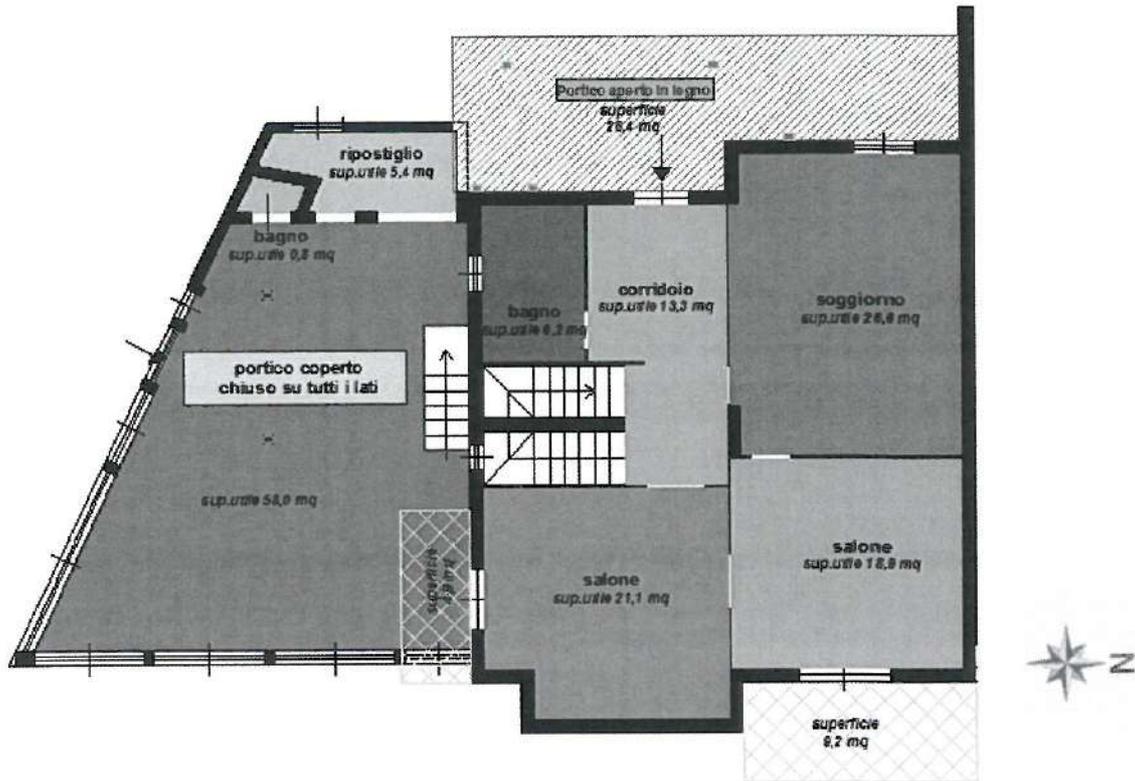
PIANTA PIANO PRIMO-STATO ATTUALE
